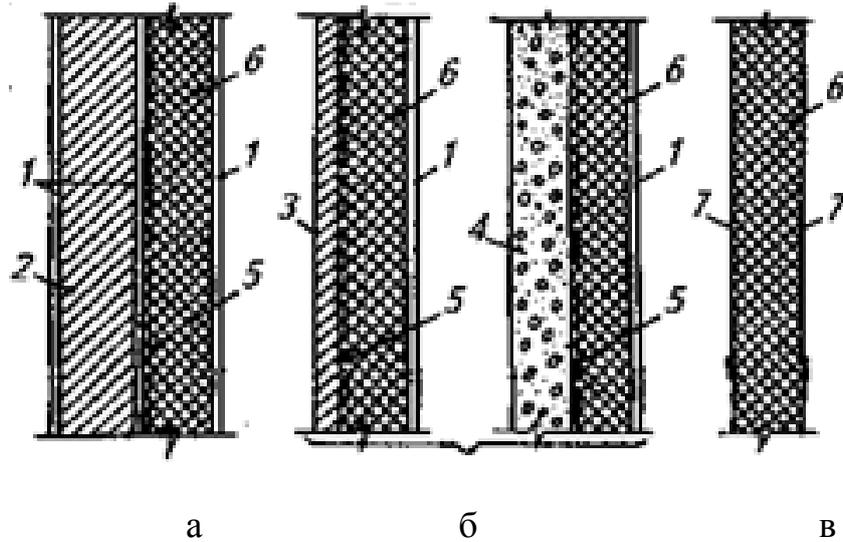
Изоляция наружных стен одноэтажного холодильника:
